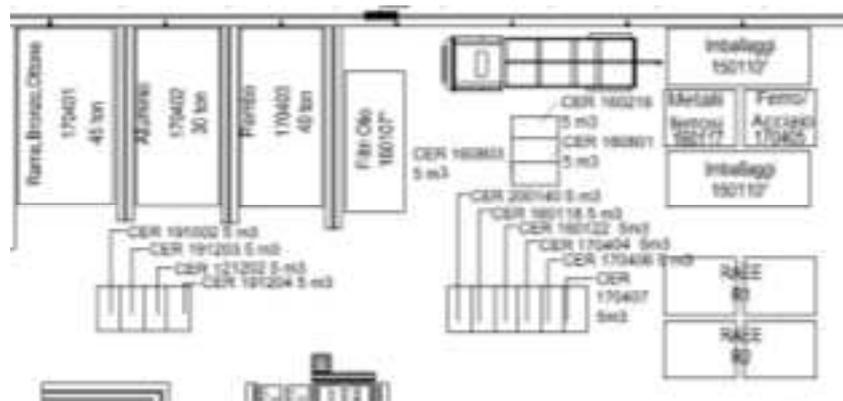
Straccio planimetrico delle aree di stoccaggio dei metalli
